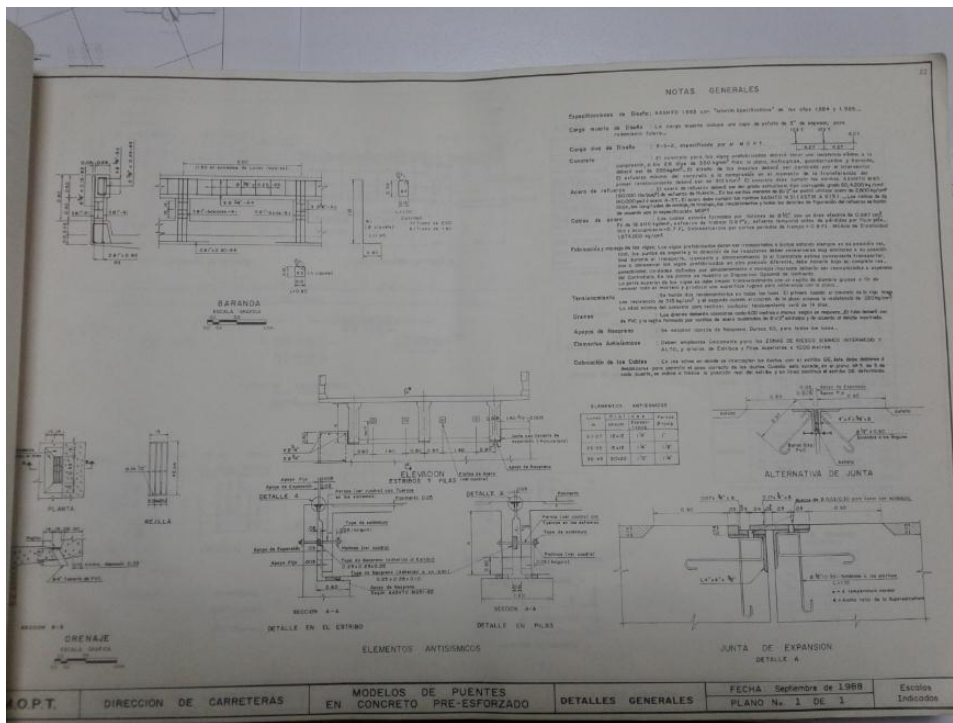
Plano Detalles generales - Modelos de puentes en concreto pre-esforzado 1 de 1.
